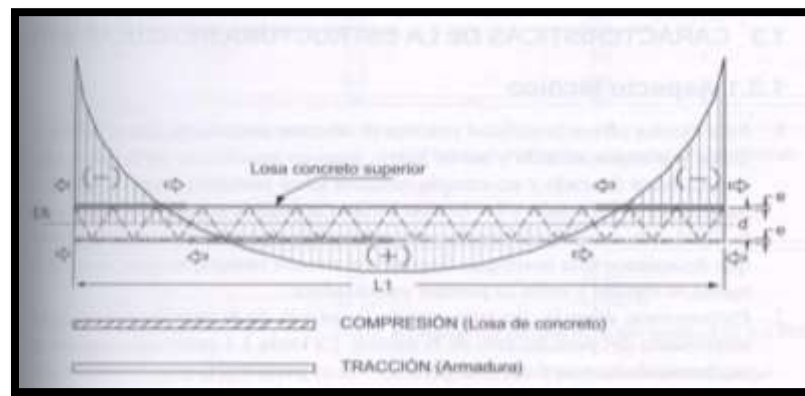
Fuerzas Internas de Compresión y Tracción en las EEM
